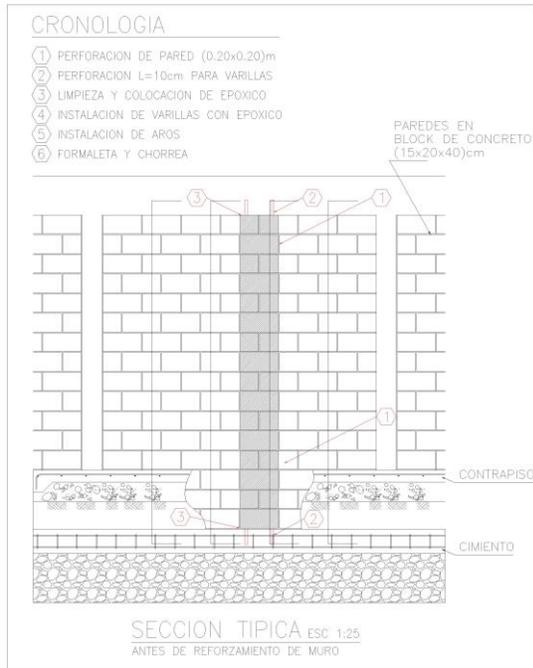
Demolición para Reforzamiento de Muro. Autocad 2005.
